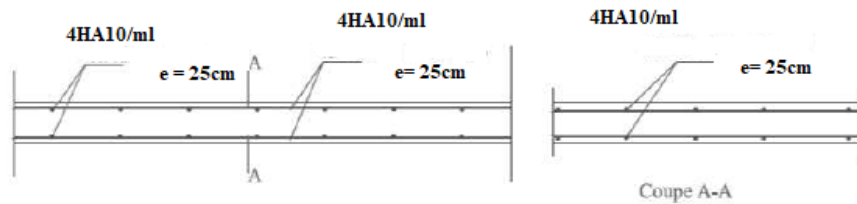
Ferrailage de dalle pleine du hall d'ascenseur.
